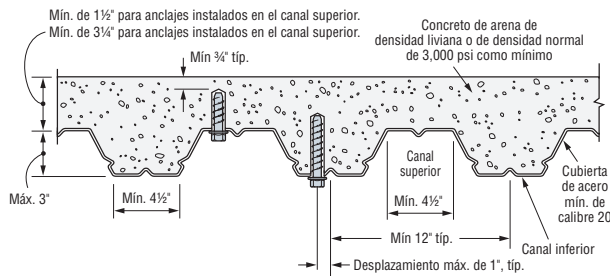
Instalación de anclajes de 3/8" y 1/2" de diámetro en el plafón de concreto sobre cubierta de acero
